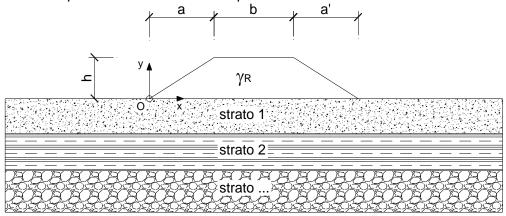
Schema di calcolo dei cedimenti del rilevato
